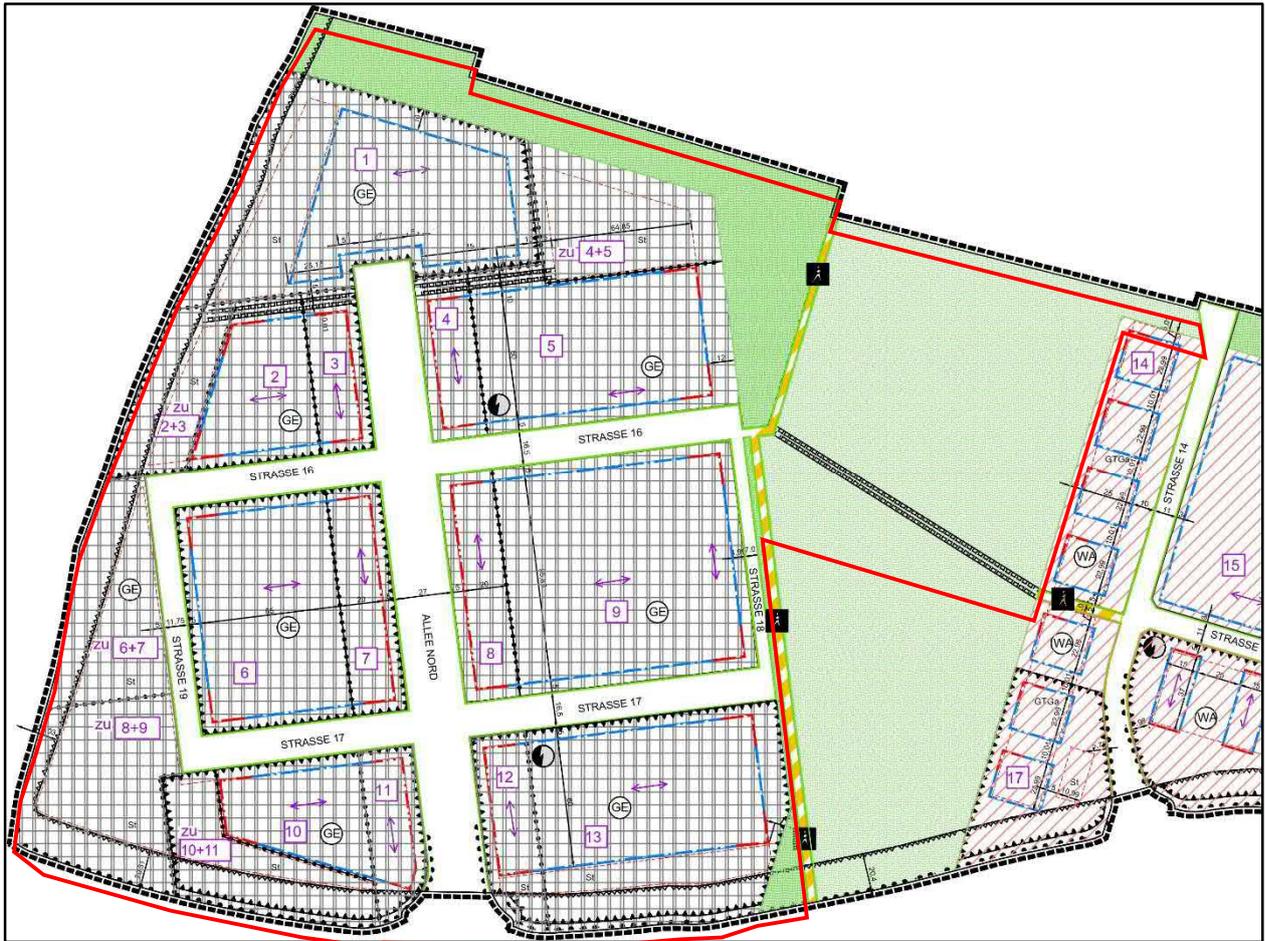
Bebauungsplan „Im Schleid“ (2004); rot = Geltungsbereich der 5. Änderung
